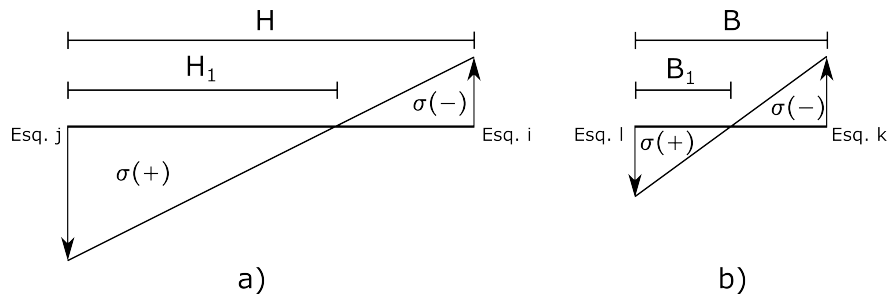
Cálculo de longitud de apoyo en cada lado de la zapata
